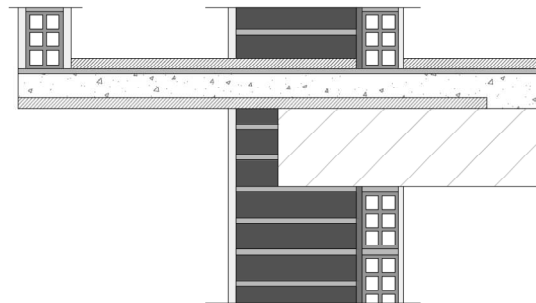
Fachada-Forjado (balcón). Zona oeste. Estado original.
